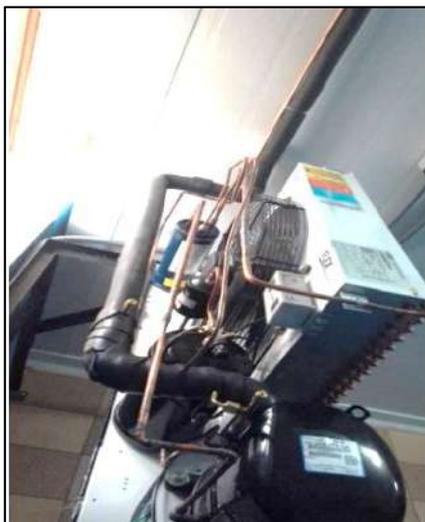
Soldadura de tubería de succión y líquido al evaporador
